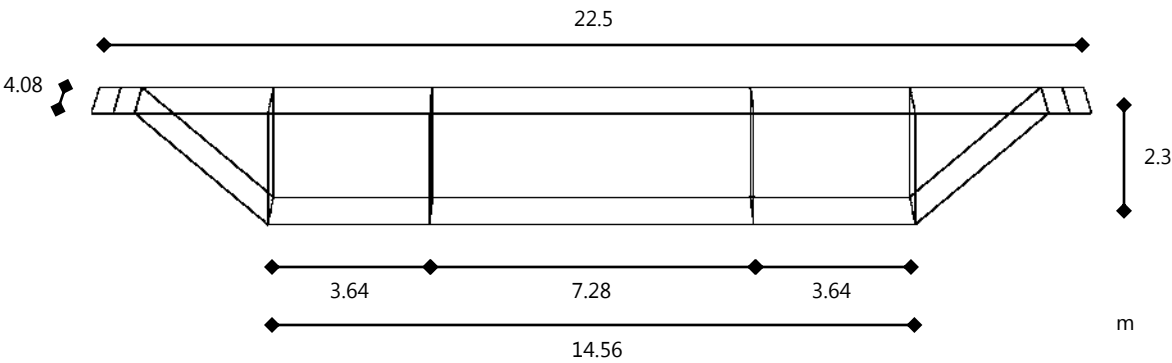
b Dimensiones del tablero del puente atirantado.
